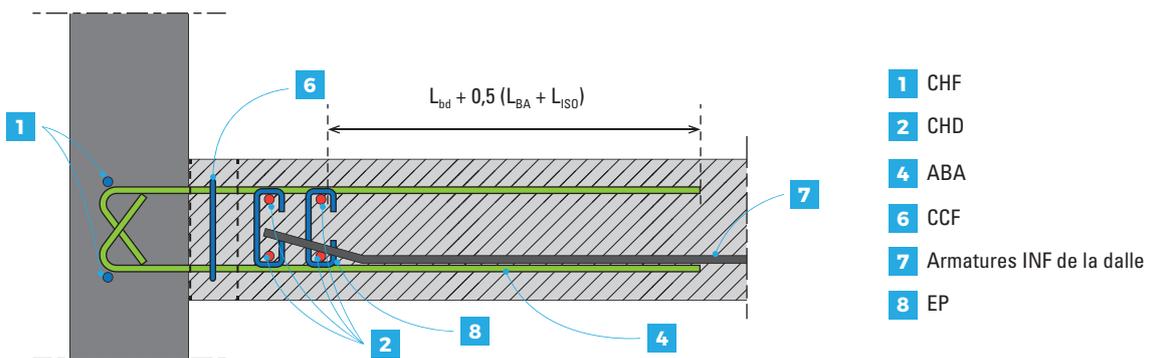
Exemple de dispositions constructives au droit d'une bande d'appui en zone courante
